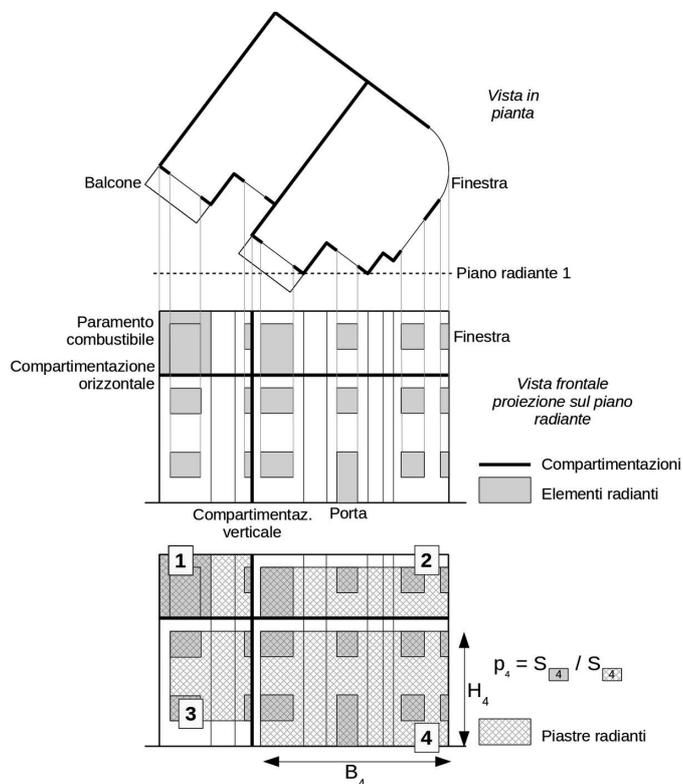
Determinazione delle piastre radianti, vista in pianta e frontale
